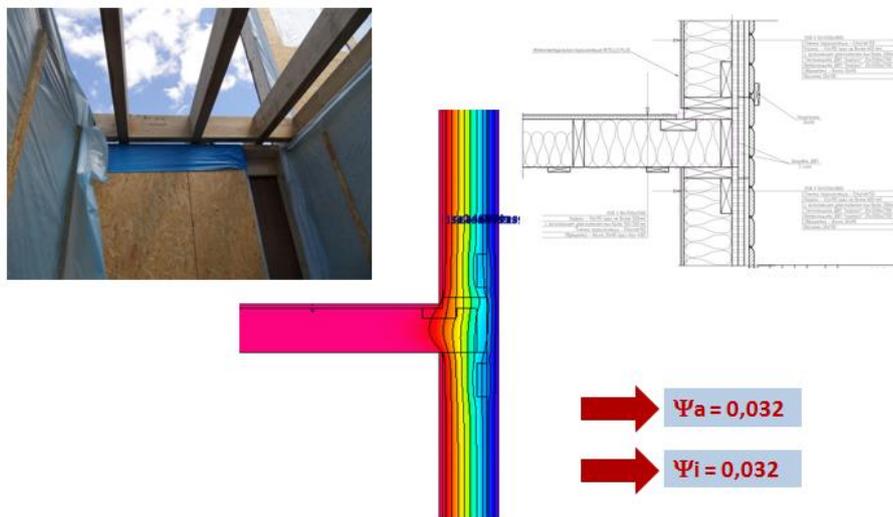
Примыкание наружной стены и межэтажного перекрытия.
